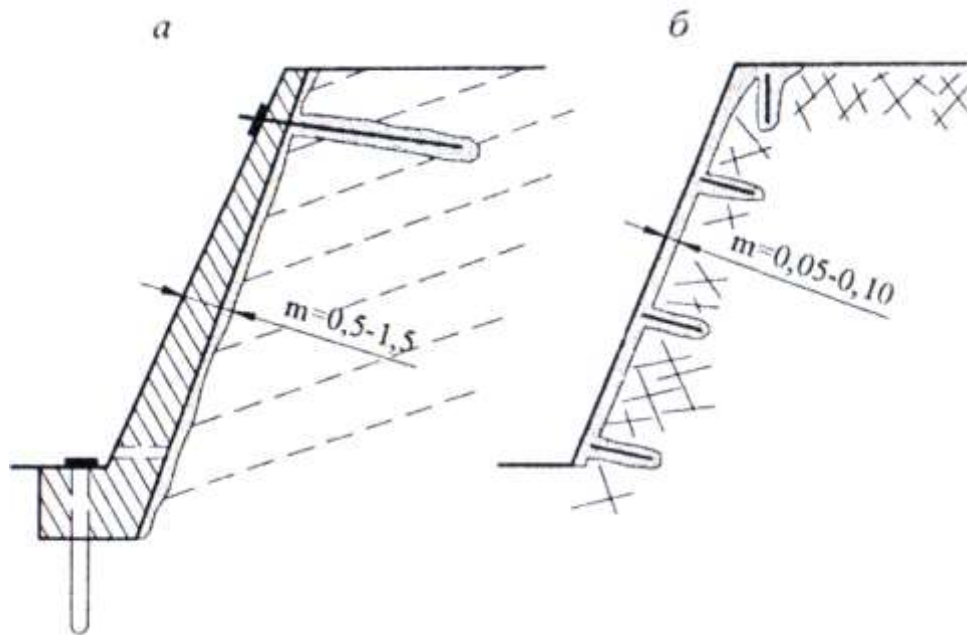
Железобетонные стенки: *а* – защитная на фундаменте; *б* – предохранительная подвесная
